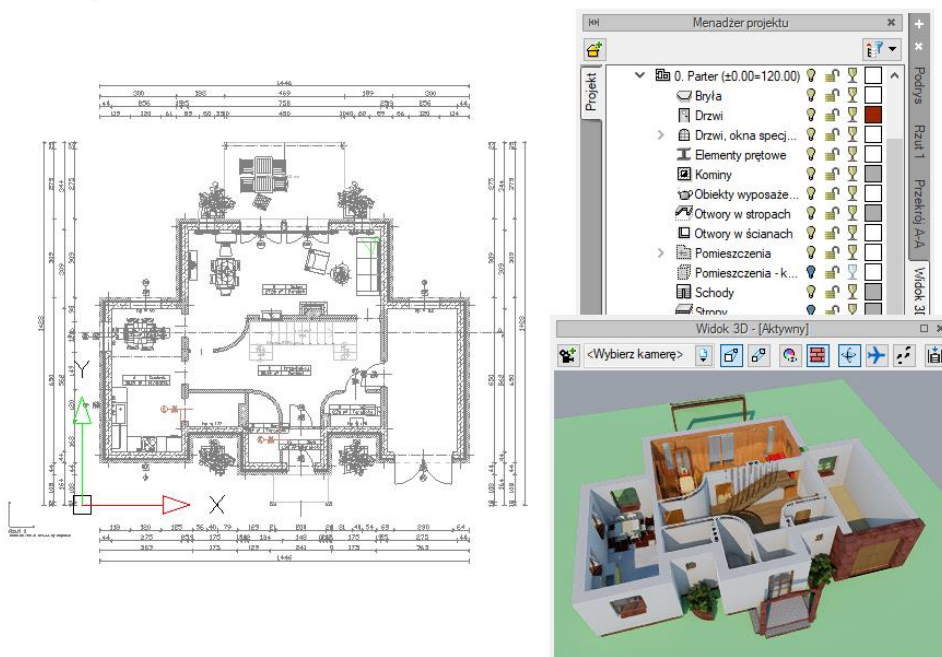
Przykład z aktywnym widokiem Widok 3D w trybie zaawansowanym
